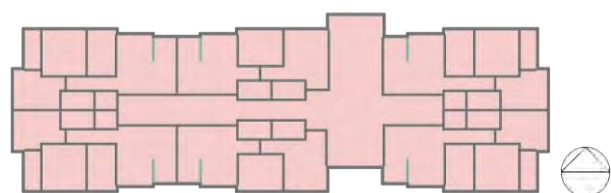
Planta do pavimento tipo no software Design Builder, conforme a metodologia de 2021.
